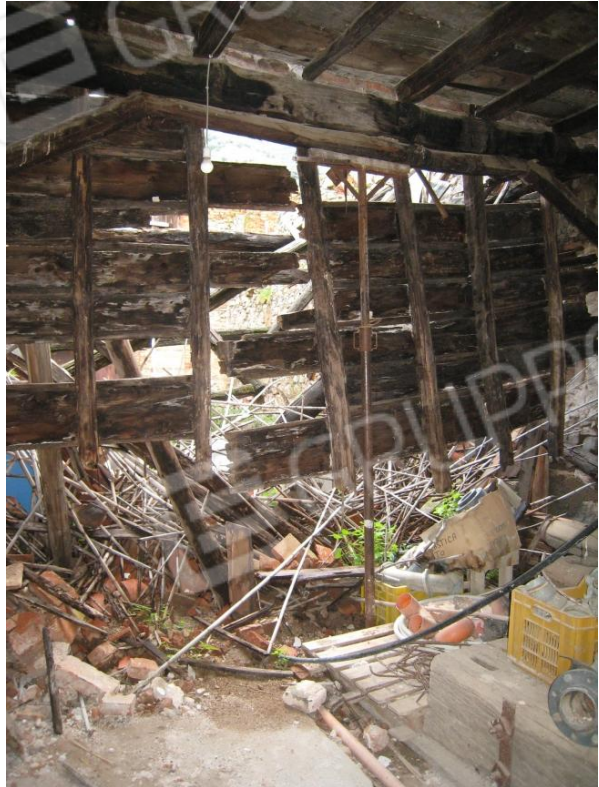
Piano terra edificio "B". Unità collabente distinta con il sub 4.
